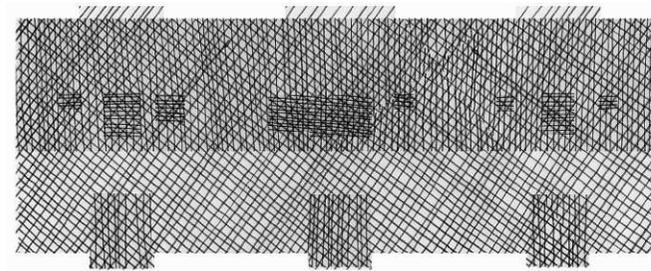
Siedlung Nachtgärtle | Grundriss | unterschiedlich hohe Grade an Definition bzw. Vorgaben
